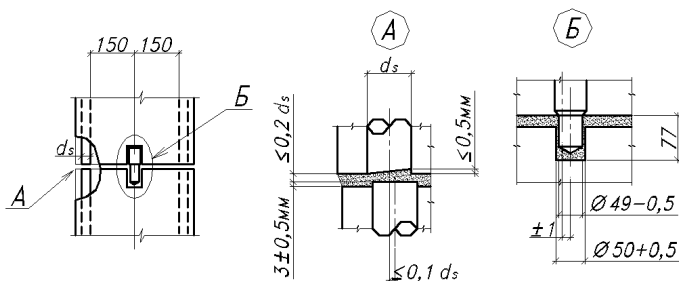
Схема плоского бессварочного стыка и допуски на изготовление и монтаж
